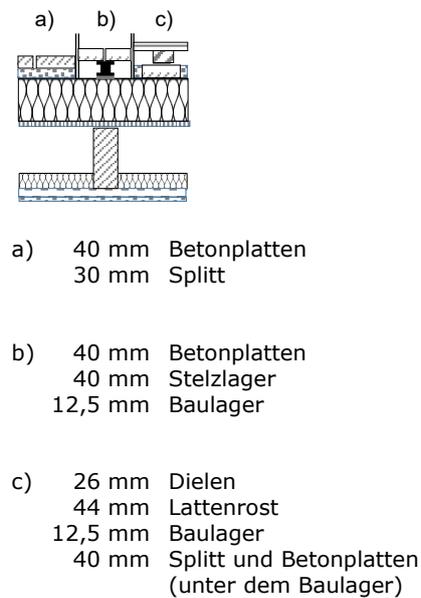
Norm-Trittschallpegel unterschiedlicher Aufbauten auf einem Sparren-/Balkenelement mit abgehängter Unterdecke und 140 mm EPS-Aufdachdämmplatten. a) Betonplatten im Splittbett,  $L_{n,w} = 44$  dB, b) Betonplatten auf Stelzlager, Entkopplung durch Baulager,  $L_{n,w} = 38$  dB, c) Dielen auf Lattenrost, Entkopplung durch Baulager, Zusatzmasse durch Splitt,  $L_{n,w} = 31$  dB
